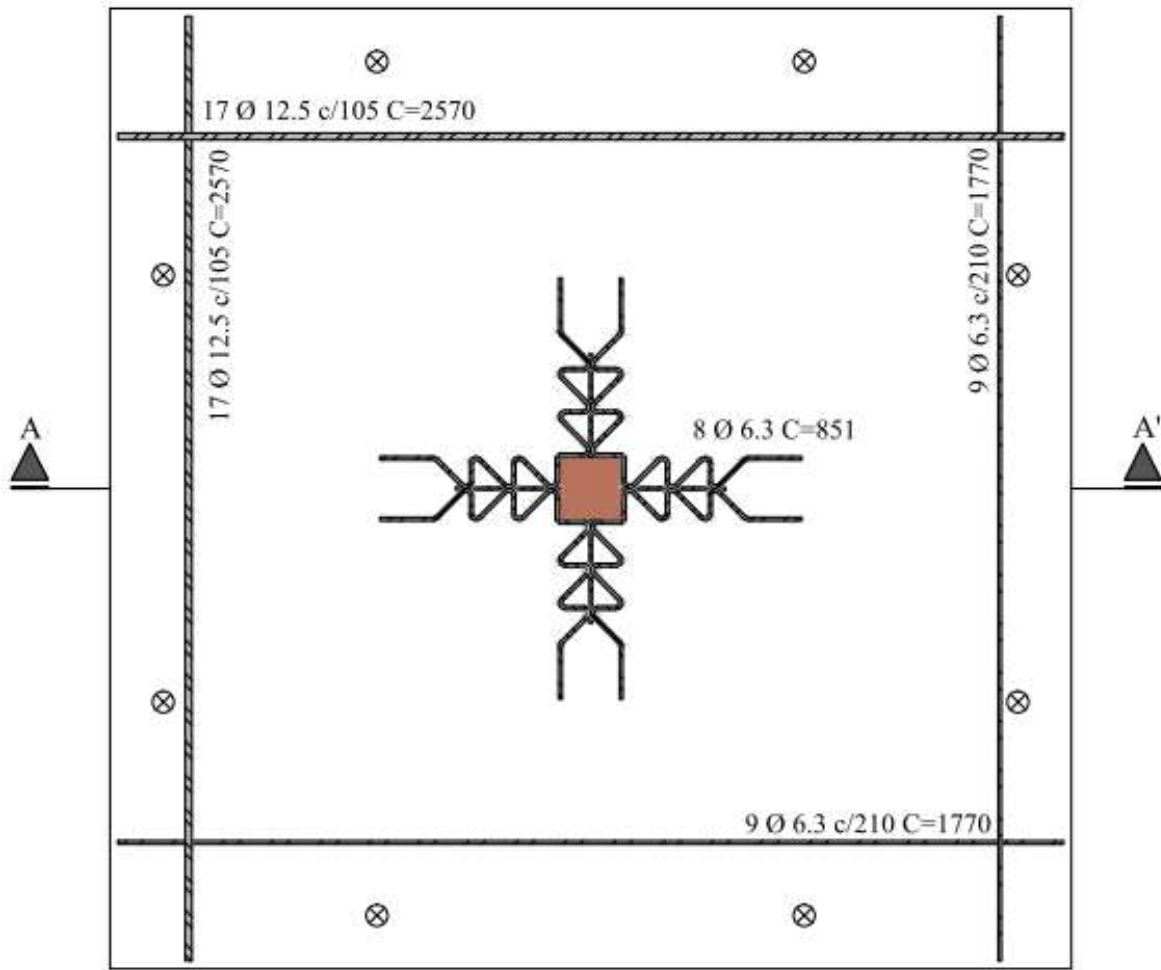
Arranjo das armaduras transversais na laje L2
